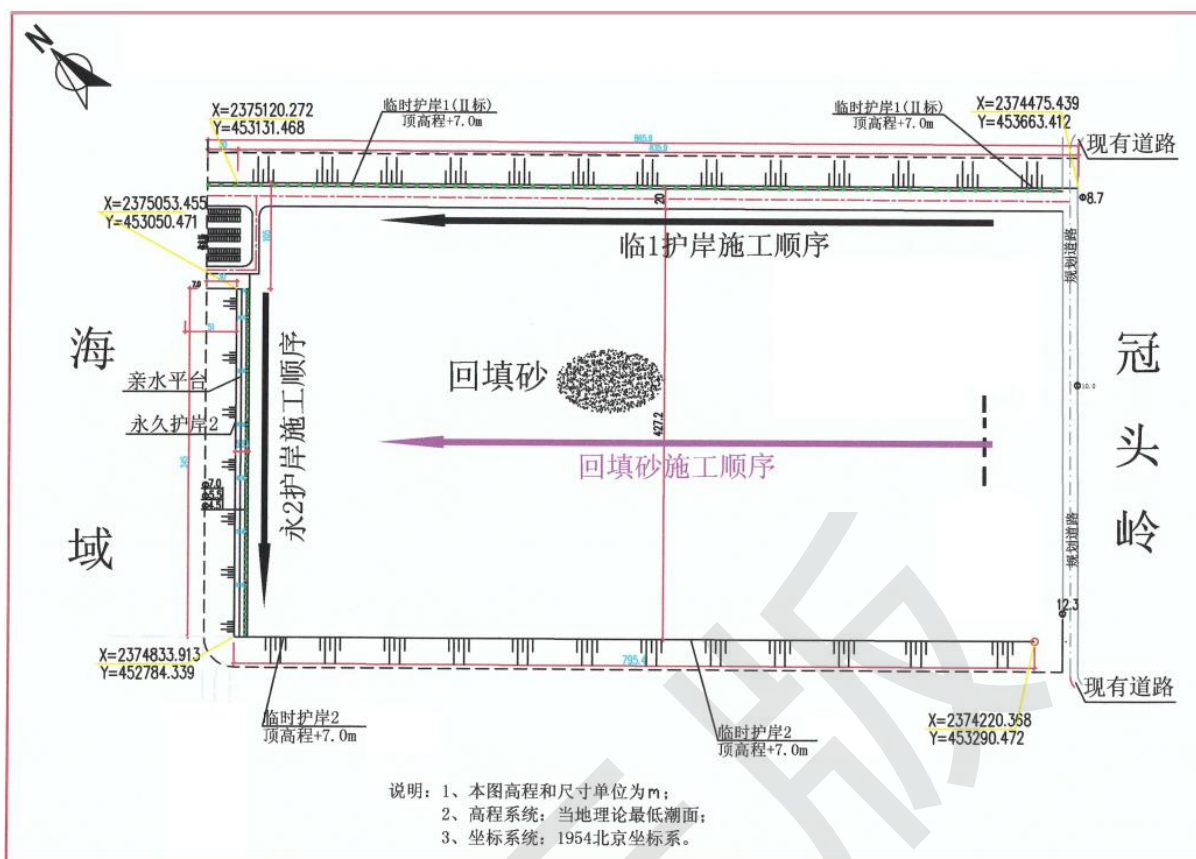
护岸工程和陆域吹填施工施工顺序布置图
